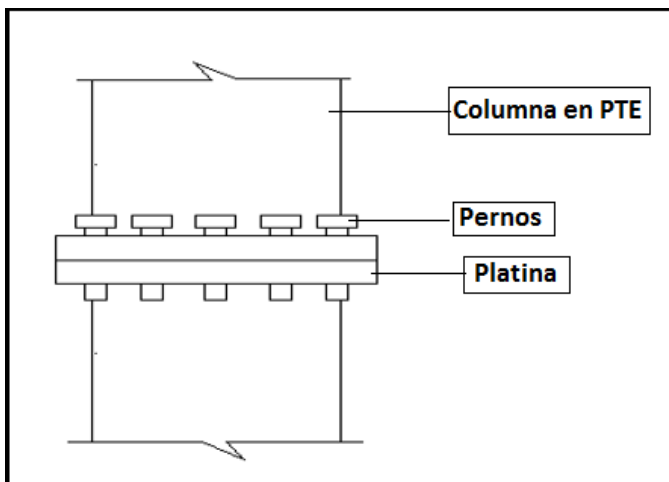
Conexión pernada tipo columna-columna. Fuente propia
